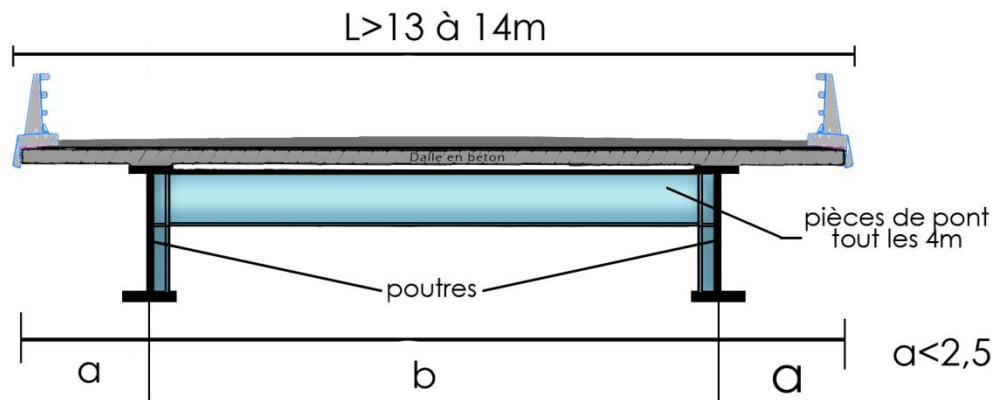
Coupe transversale d'un tablier Bipoutre-mixte type.
